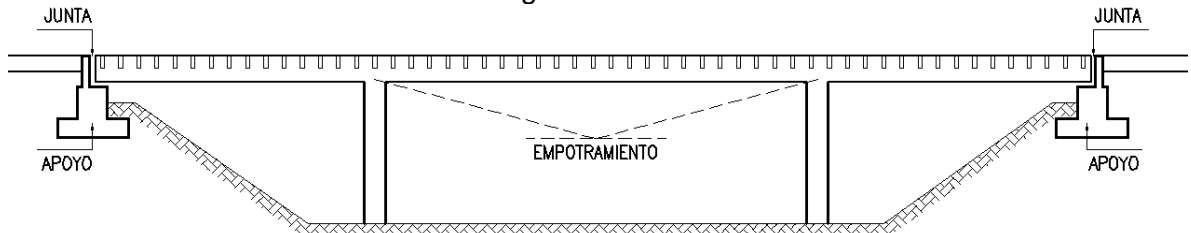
Puente con tableros continuos en las pilas y juntas en los estribos. Segunda generación.
